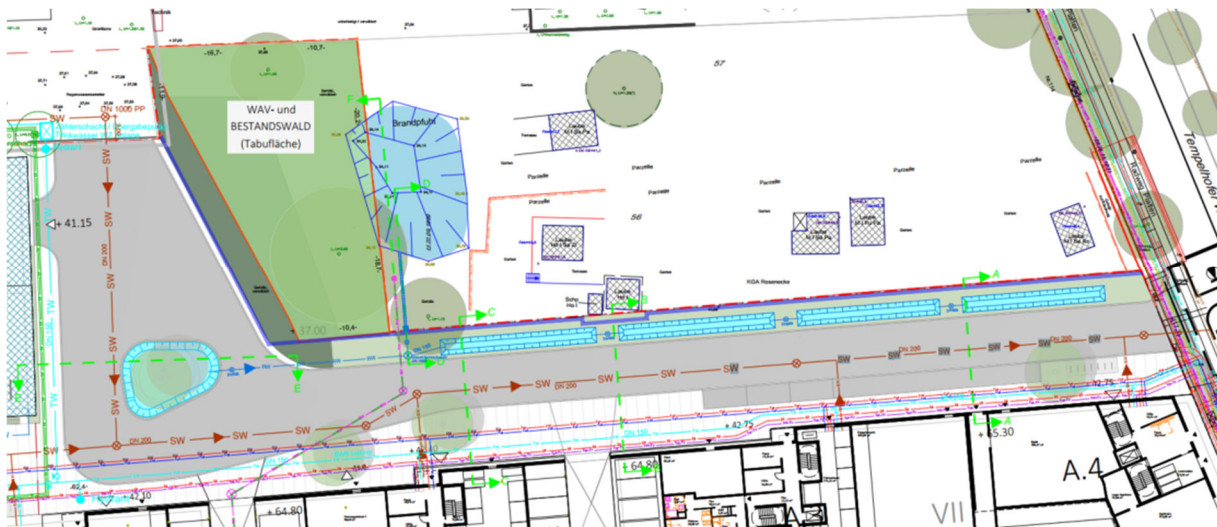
Geplante Straßenentwässerung für die Planstr.1 mit Mulden-Rigolen-System (Quelle: InfraBB)
